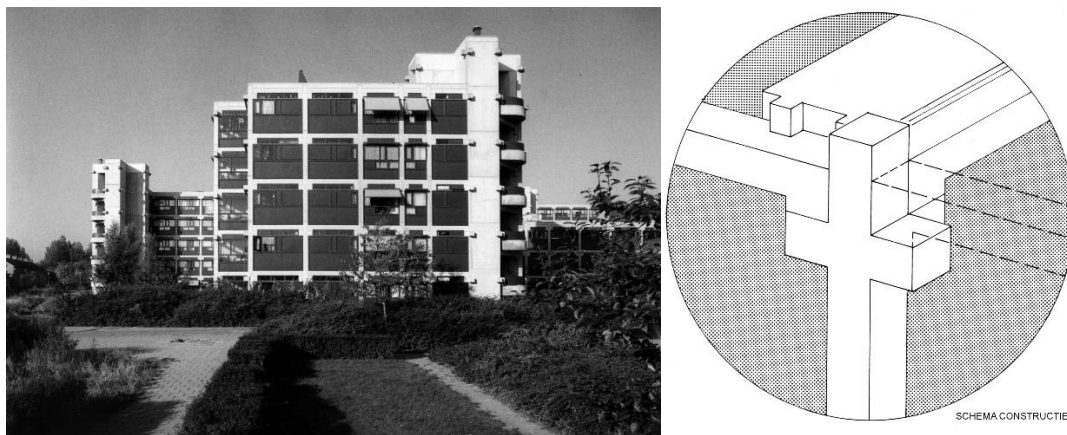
De Drie Hoven* (maison pour personnes âgées - Amsterdam) projet conçu selon le principe mis au point par Herman Hertzberg. Photo et schéma constructif poteau poutre et dalles préfabriquées. Exemple de conception pour le réemploi.
